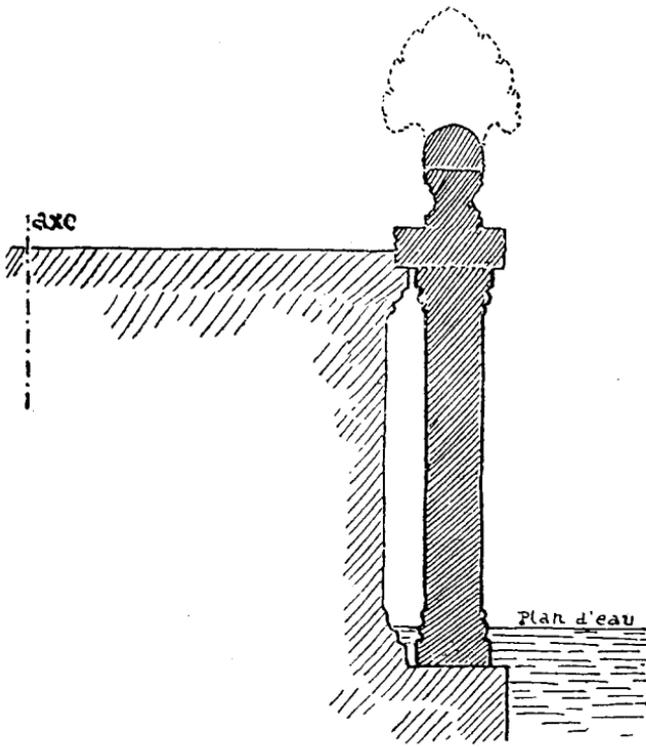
COUPE DE LA CHAUSSÉE TRAVERSIÈRE D'ANKOR VAT.
